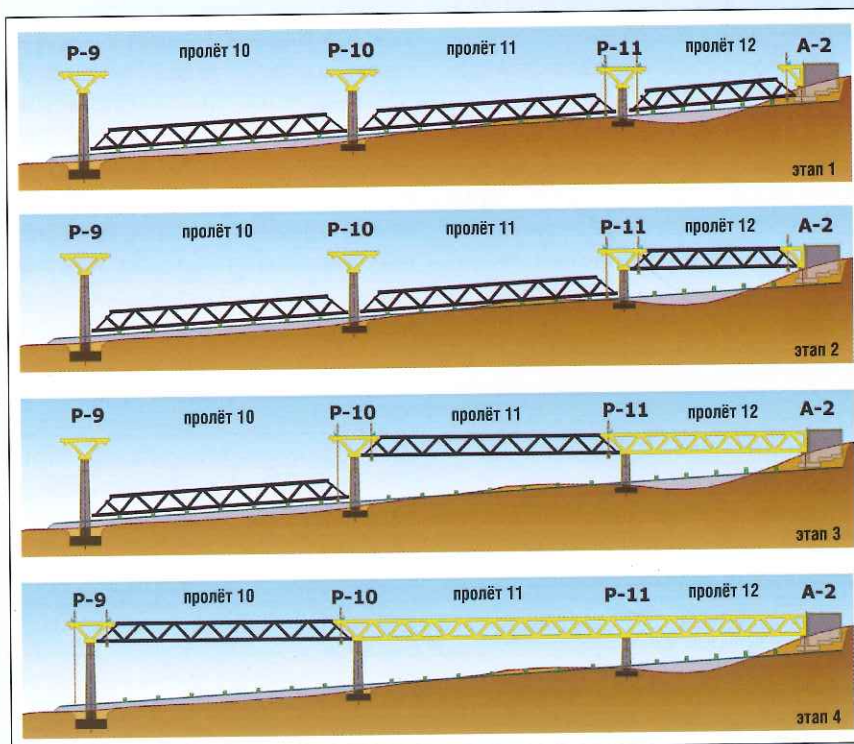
Схема монтажа пролетных строений подходов пролетов вблизи устоя 2
